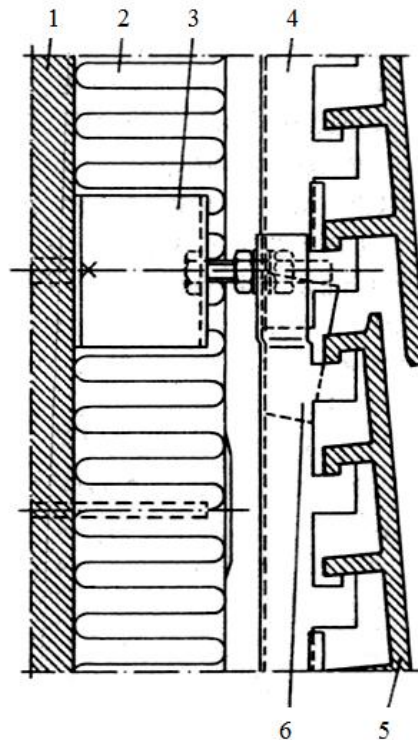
Под облицовочная несущая конструкция из алюминиевых профилей для крепления облицовки из стекла
